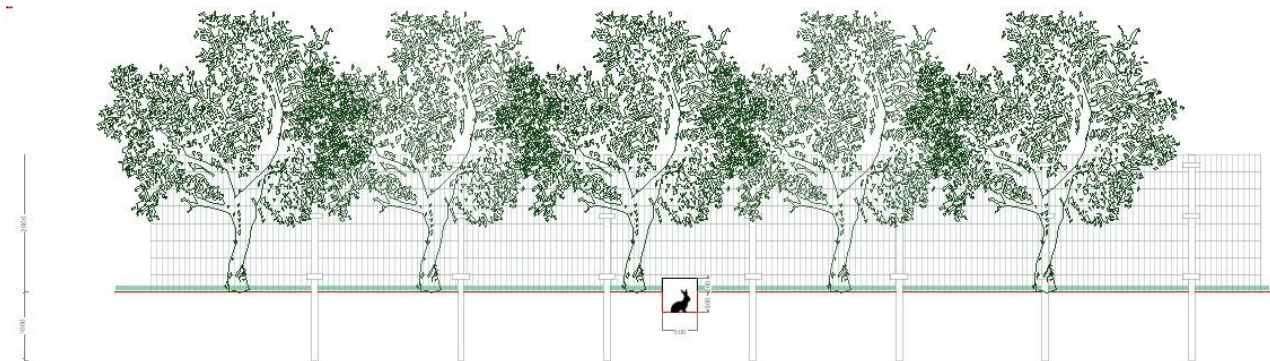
Tipico fascia perimetrale a verde e passaggi faunistici
